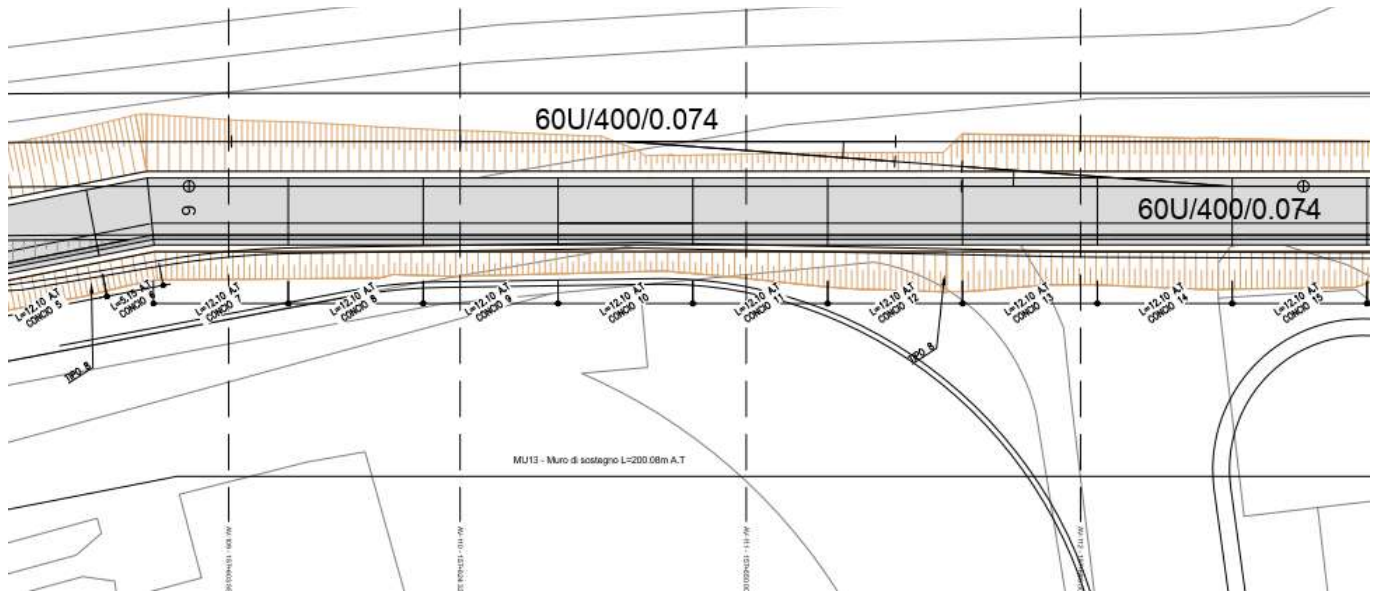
Stralciamento planimetrico di esempio con pianta scavi
